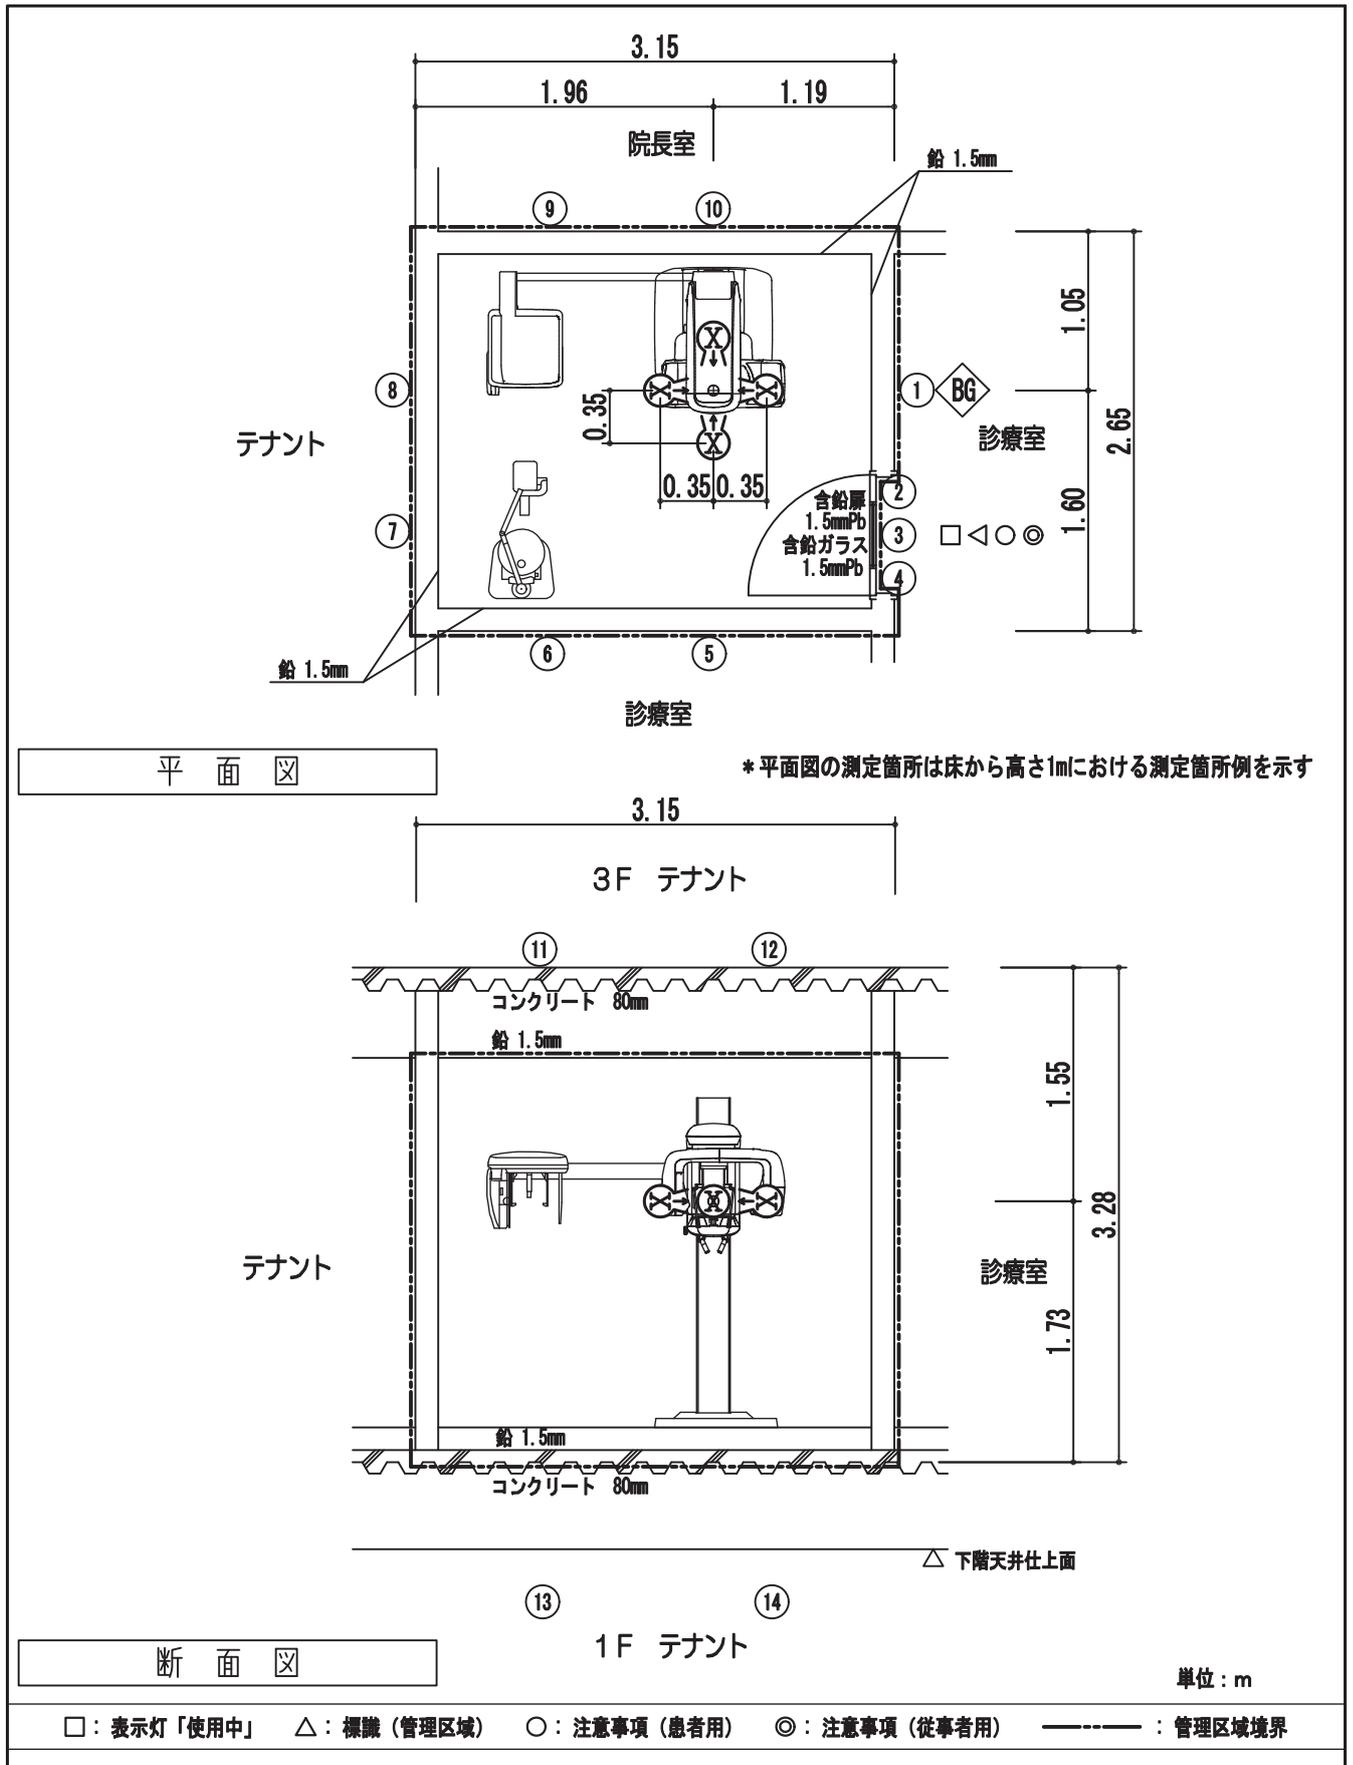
歯科用X線装置 歯科CT撮影 平面図・断面図
